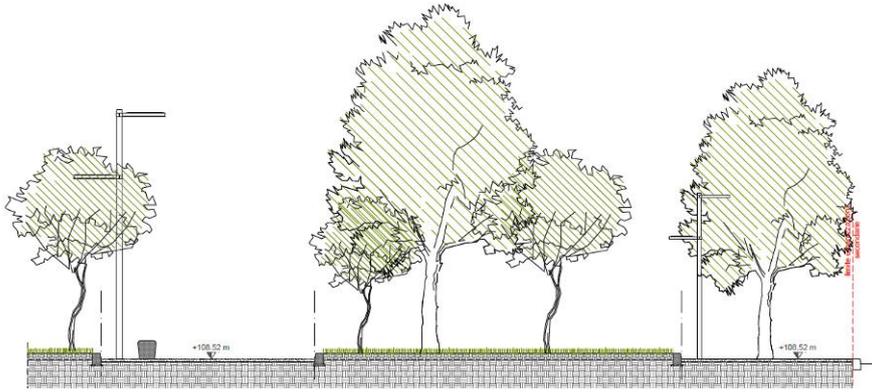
Sezione tipo dei percorsi all'interno dell'area verde.
